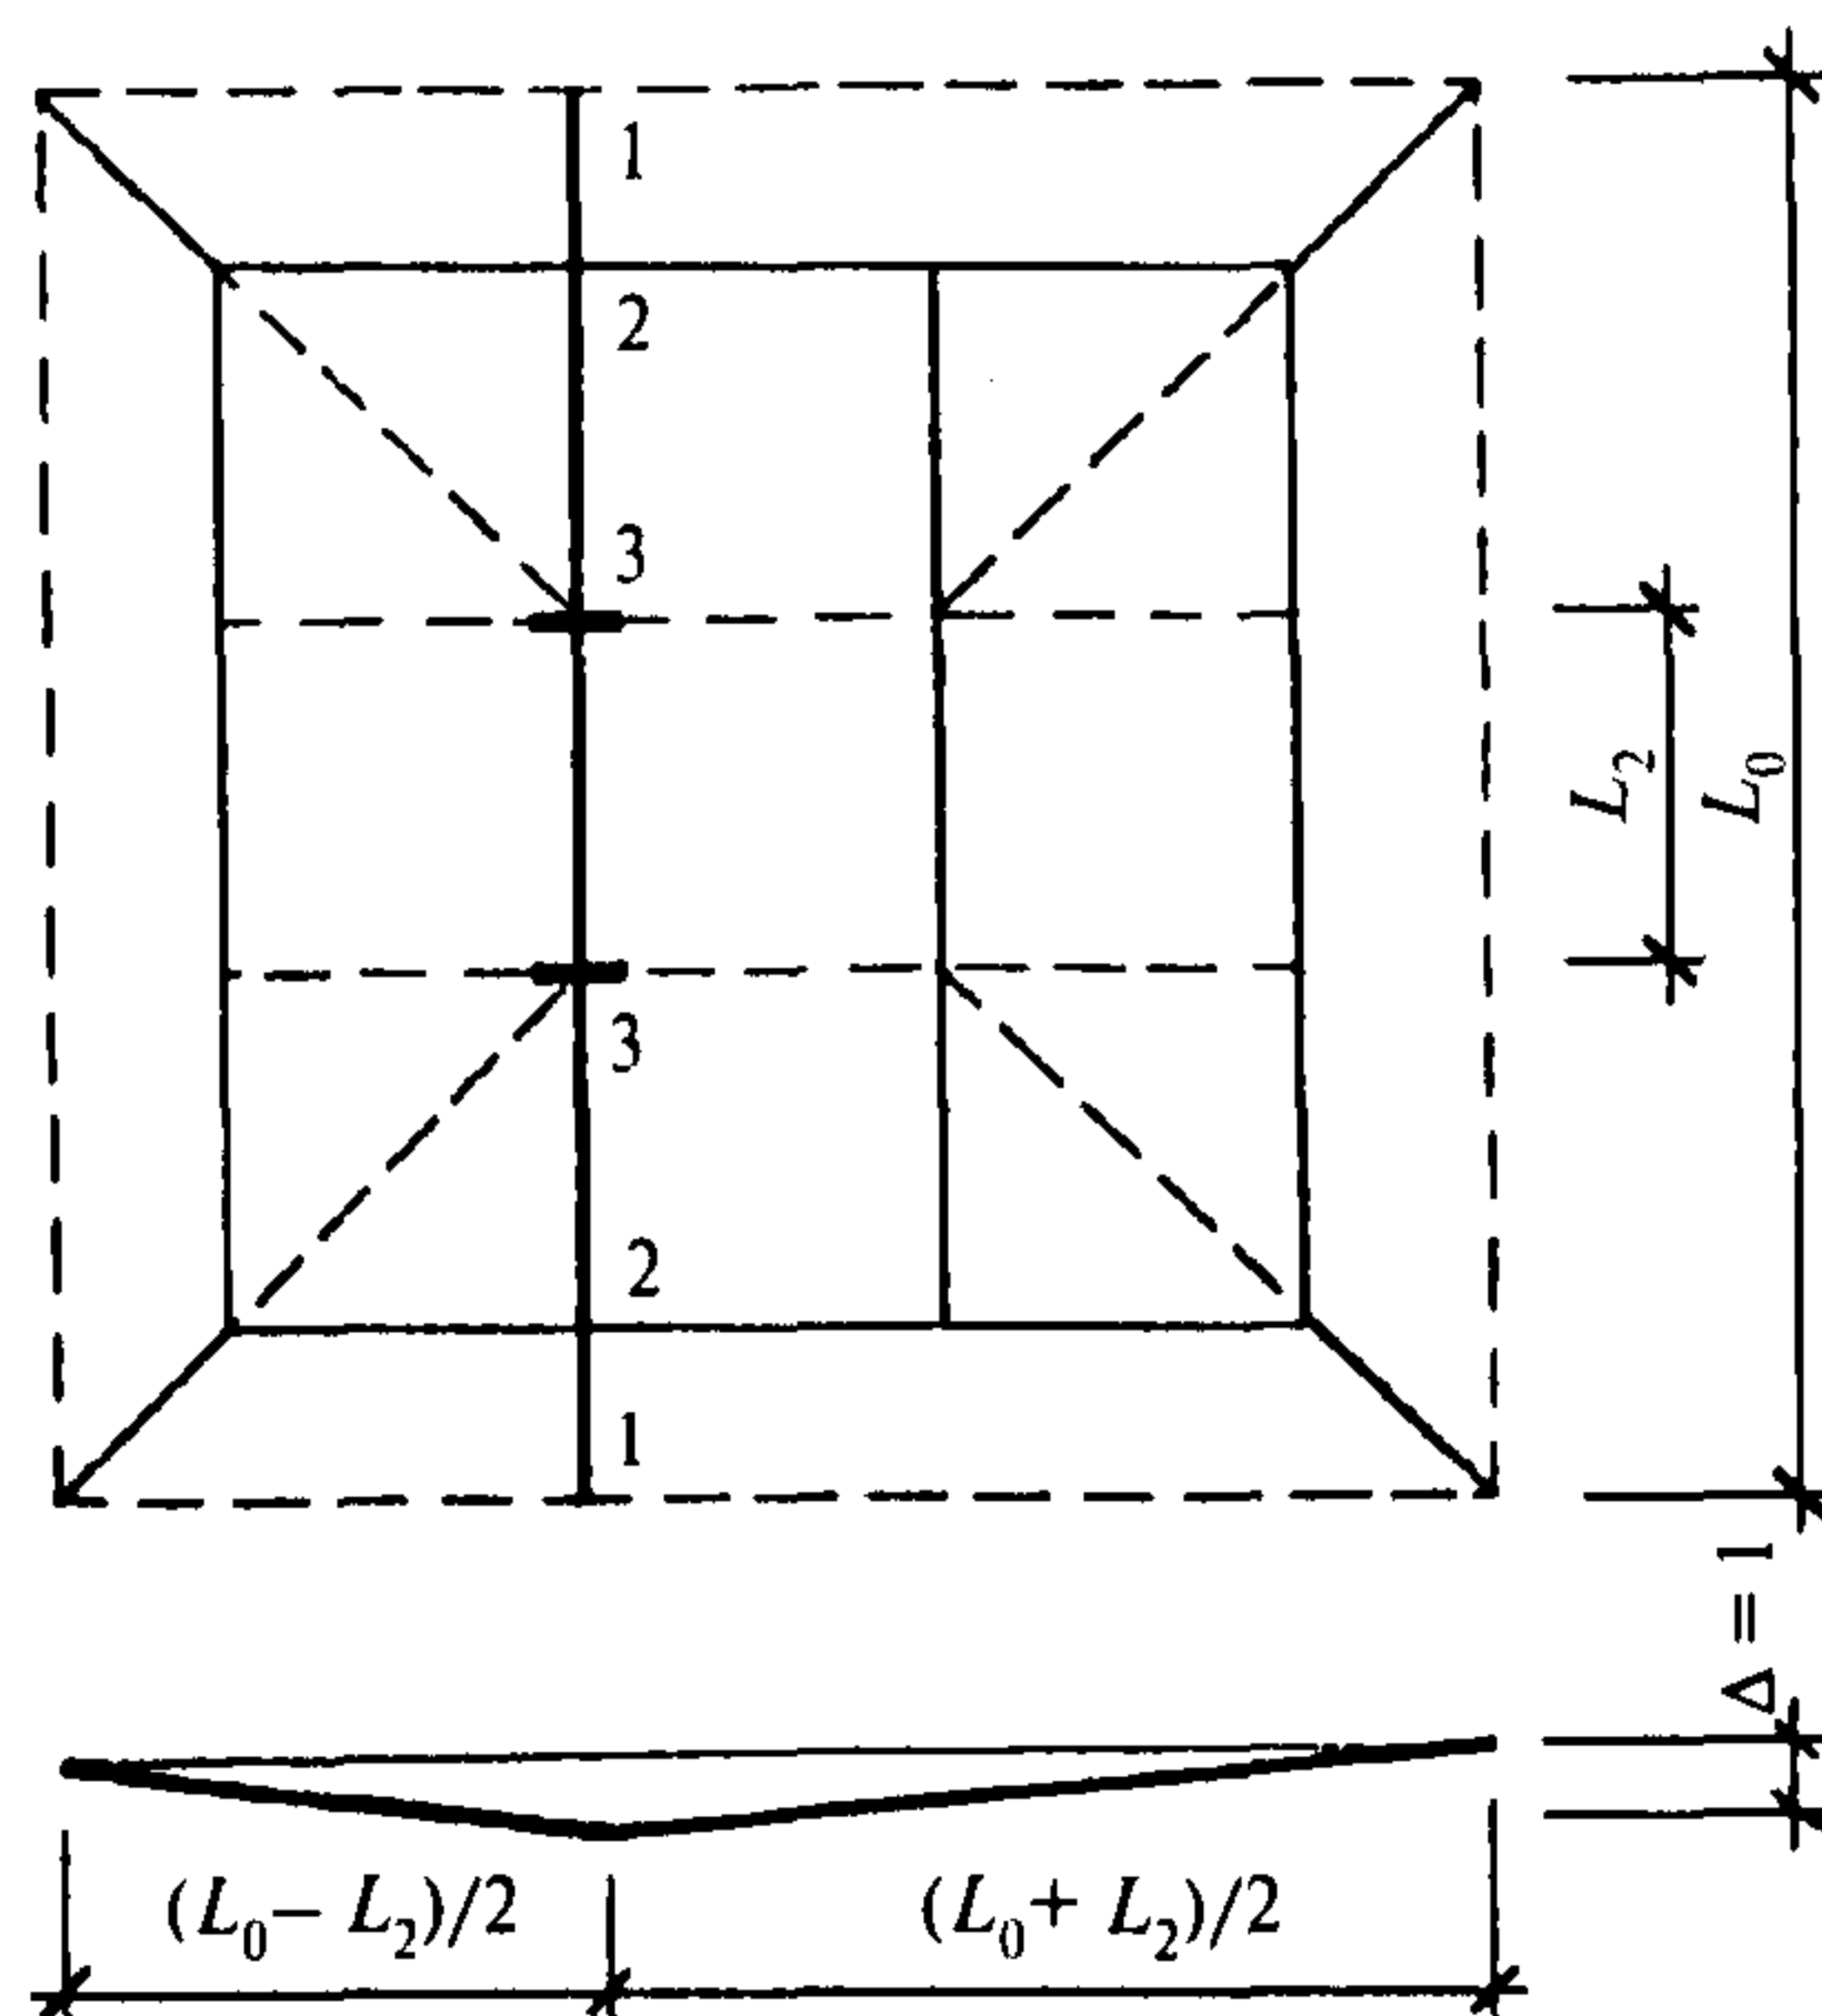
Схема разрушения с расположением линии излома в шве между плитами средней зоны перекрытия:
